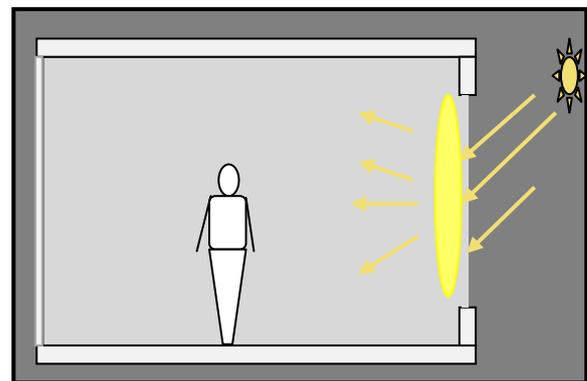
Façade sans dispositif d'ombrage. (Source : Auteur)
